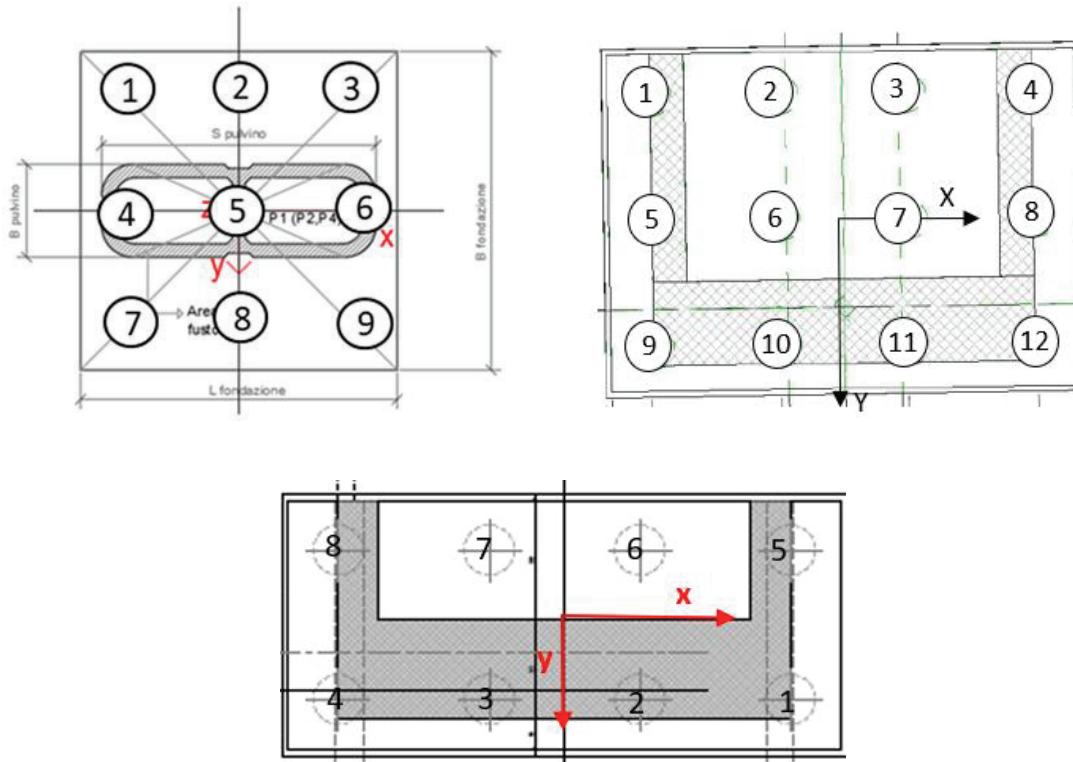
Sistema di riferimento per le fondazioni delle pile e delle spalle con indicazione della numerazione dei pali
